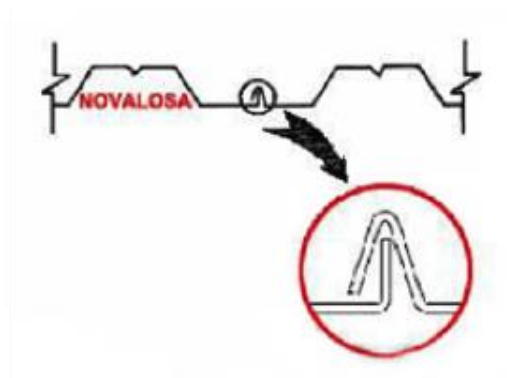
Detalle traslape placa NOVALOSA
